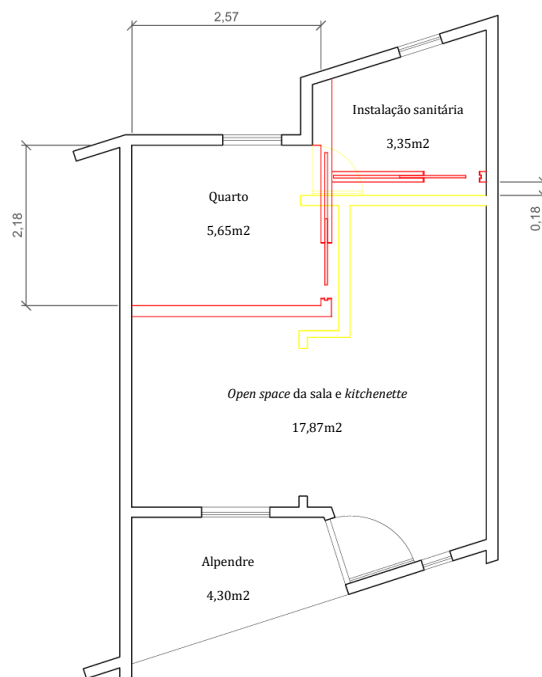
Planta de Alteração - *Bungalow 3* (Fonte: autora)
